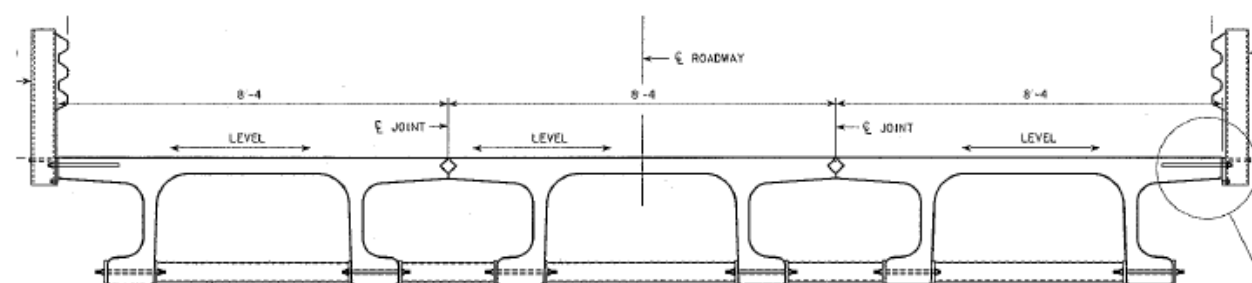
Sección transversal del puente a 1/3 de vano [Graybeal 2009]
